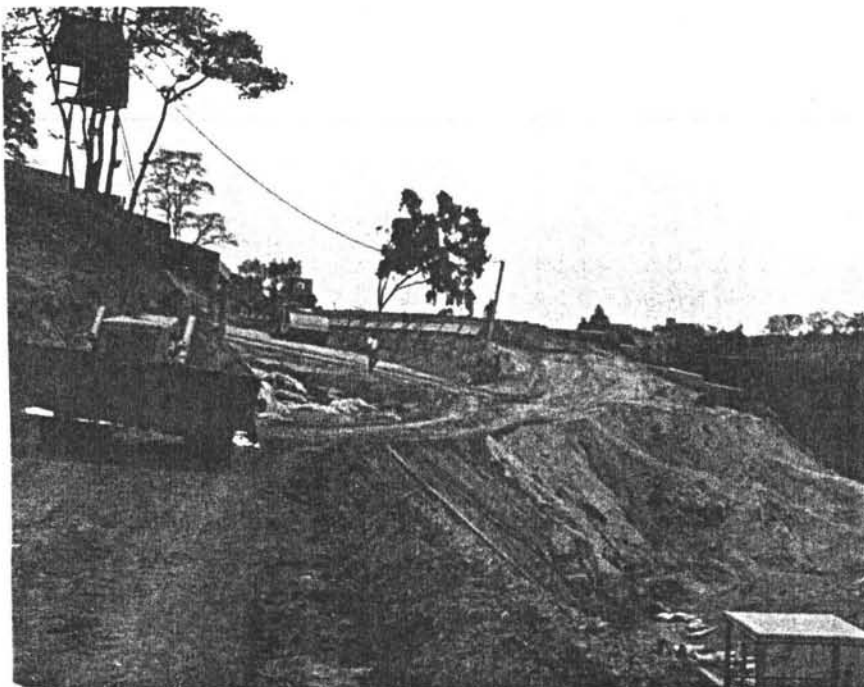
Equipo convencional utilizado en la construcción del muro de Suelo-Cemento.
